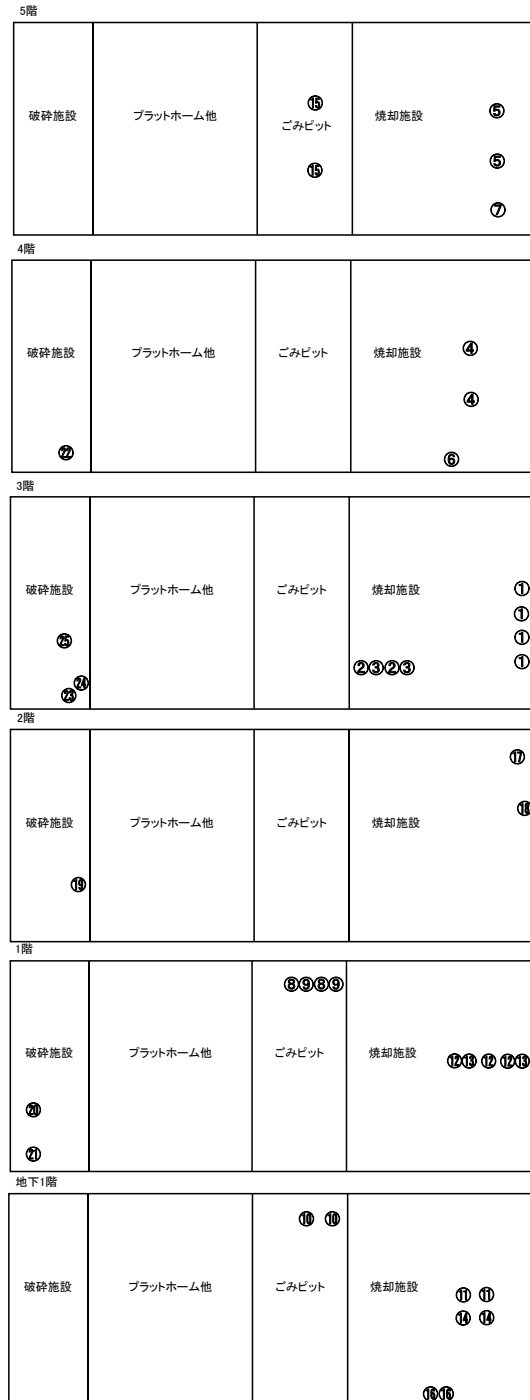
振動を発生させる主要な設備機器の配置図（平面図）
